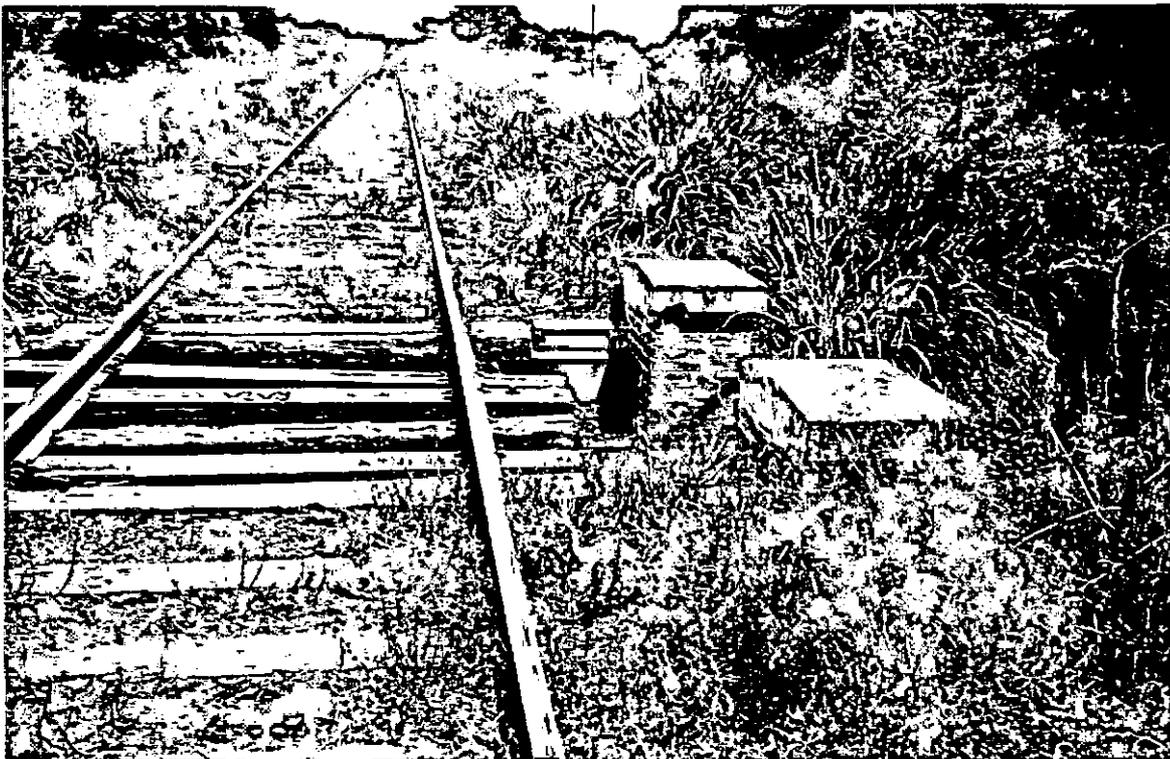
Lugar donde se proyecta uno de los cruces de la cañería de distribución por debajo de la vía a través del sifón del canal de riego
